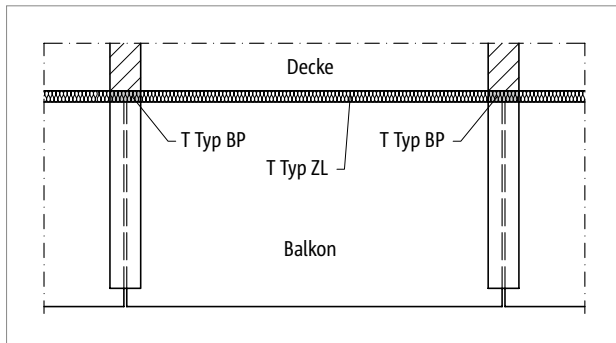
Schöck Isokorb® T Typ BP: Balkonkonstruktion mit frei auskragenden Unterzügen (Fertigteilbalkon)
